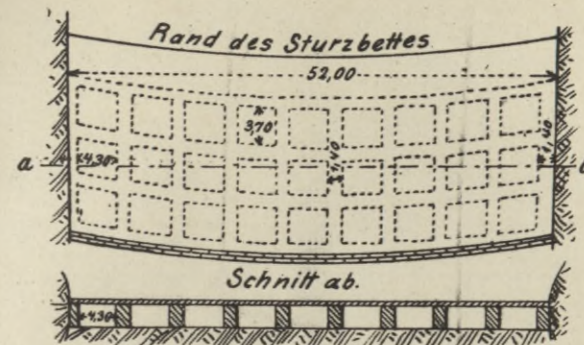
u. 3. Grundriss und Längsschnitt des Grundablasses.
